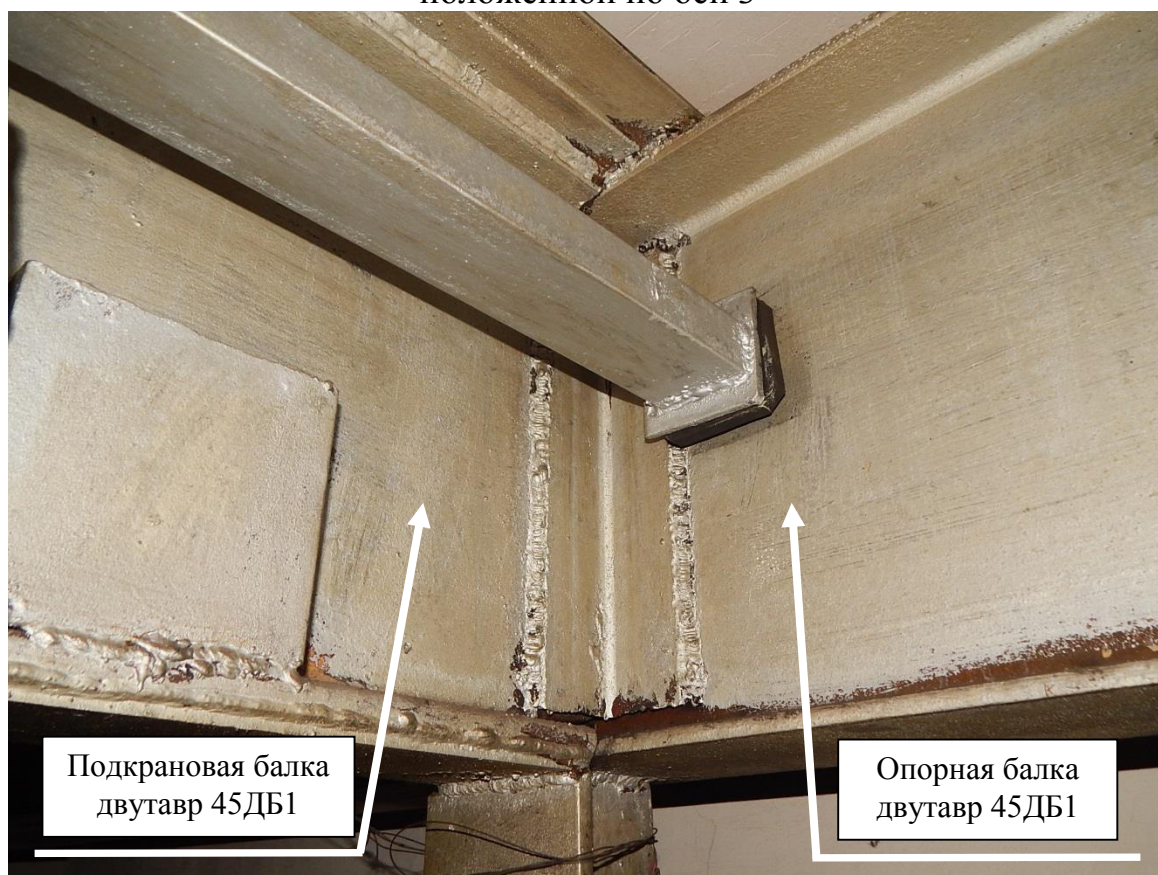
Узел сопряжения подкрановой балки с опорной балкой, выполненный посредством сварного соединения
